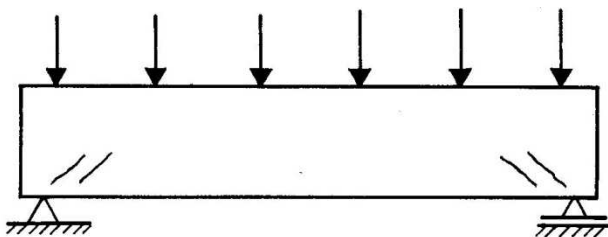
FISSURAS DE CISALHAMENTO EM VIGA SOLICITADA À FLEXÃO
